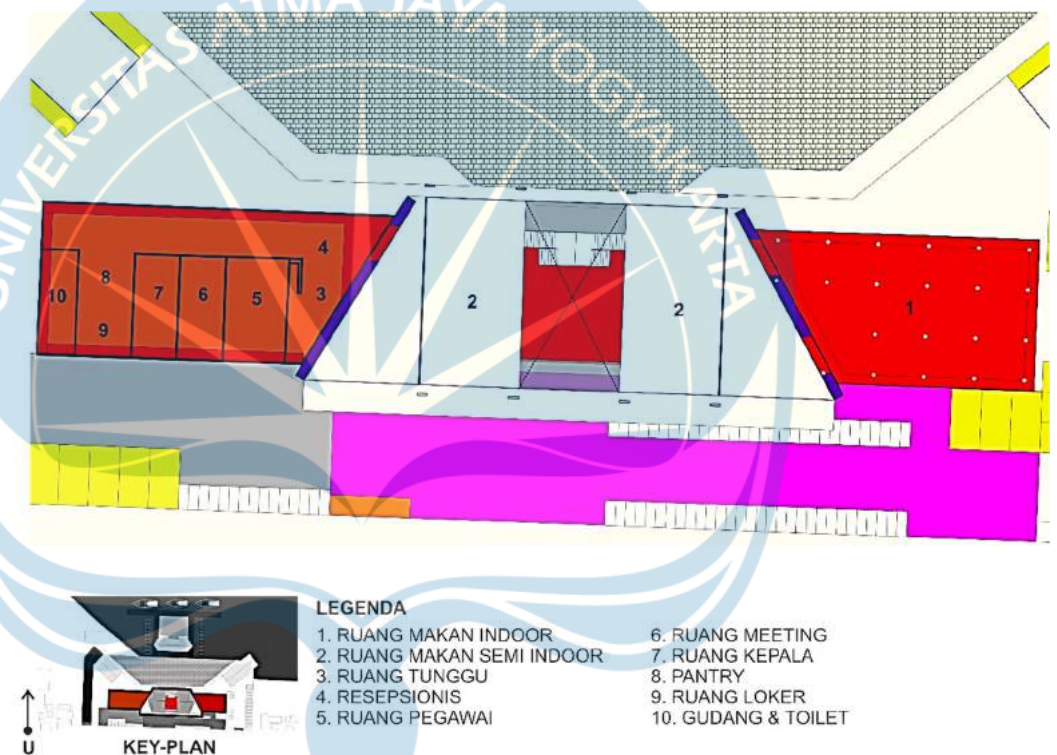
Tata Ruang Bangunan Kuliner *Indoor* dan Pengelola lantai 1
